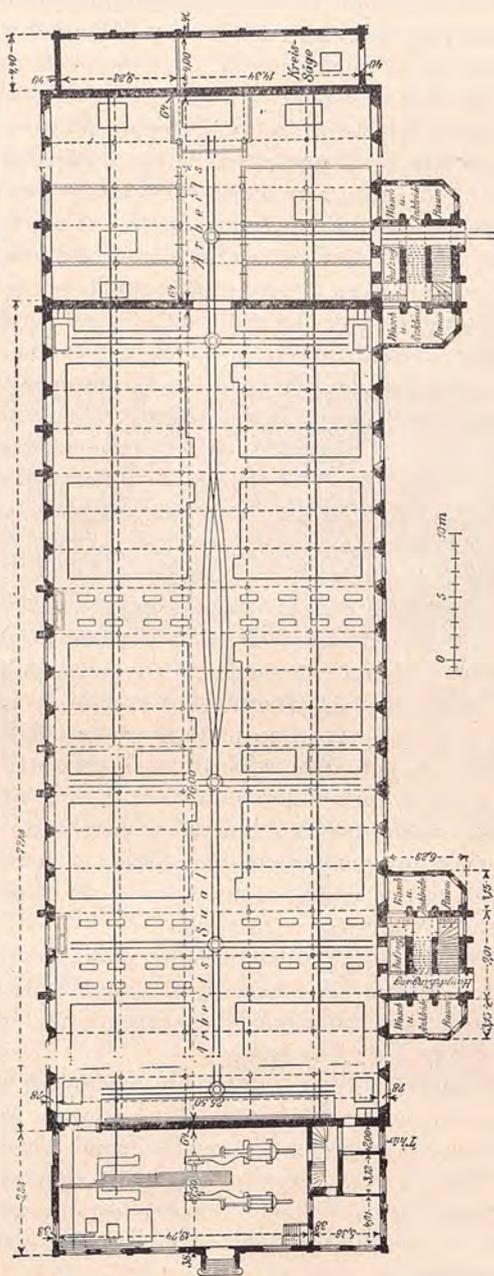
Disposizione delle scale nel lanificio Lewing a Gottinga.
